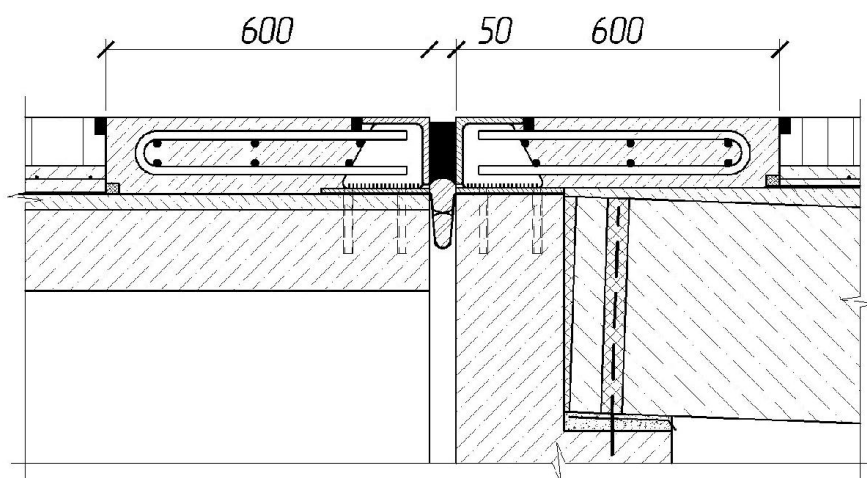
конструкция шва ДШ заполненного типа с окаймлением
